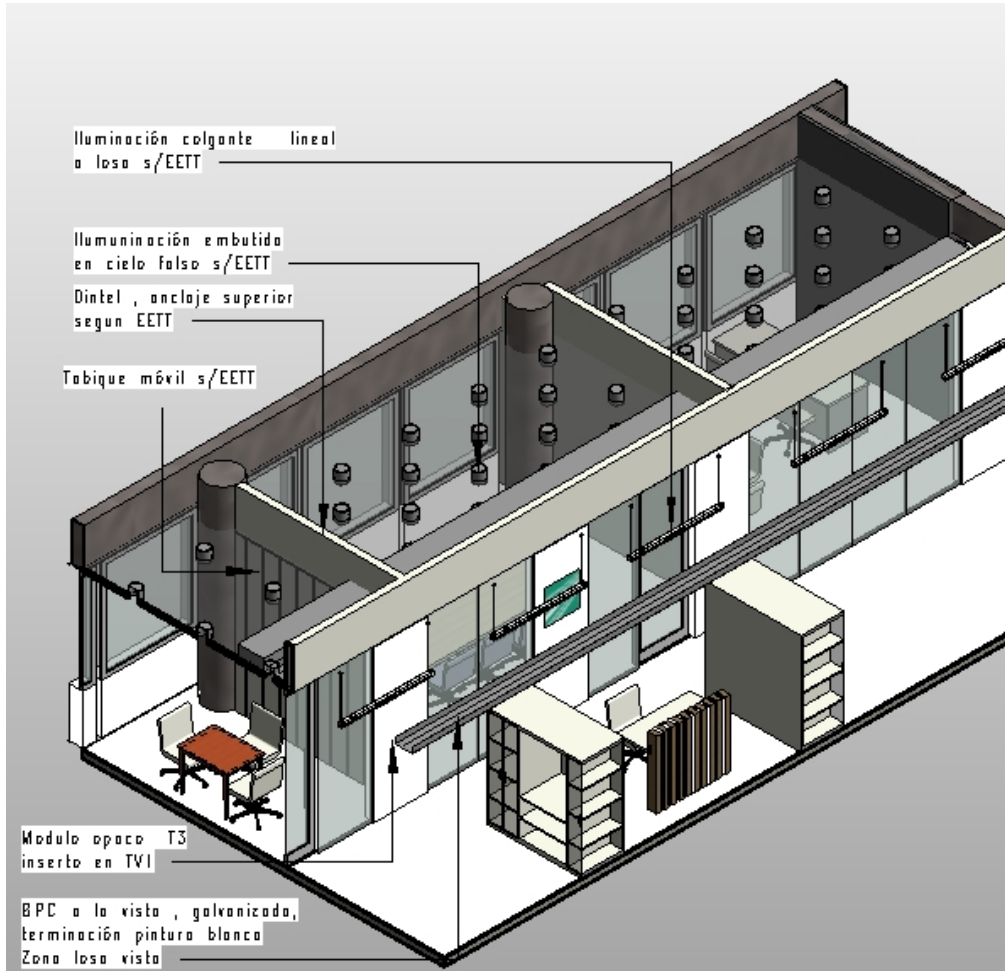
3D Zona planta libre/reunión, losa a la vista/cielo modular
